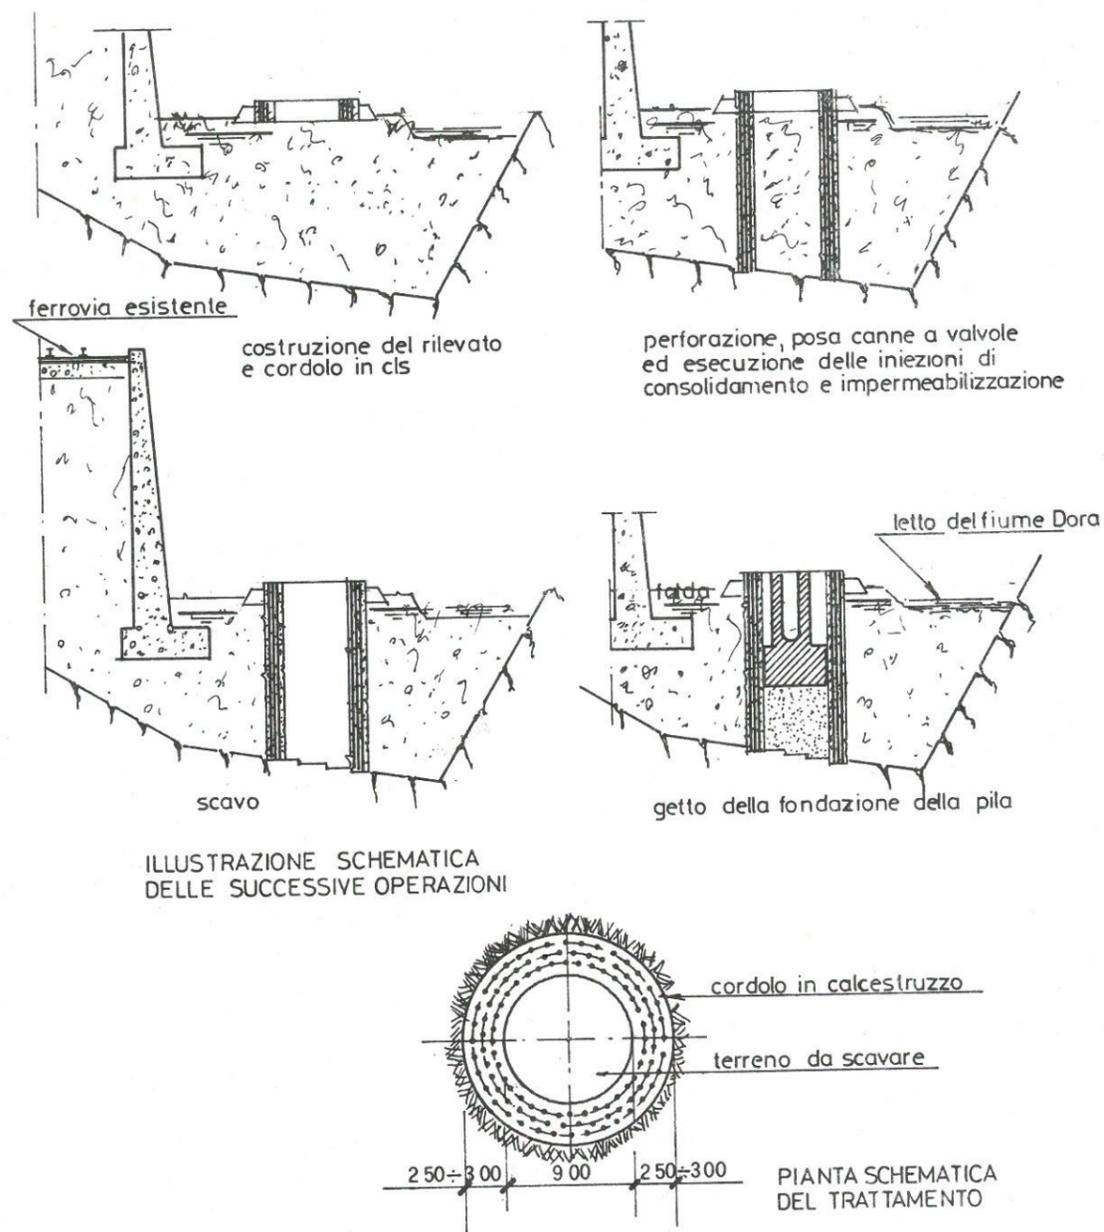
Le varie fasi di un intervento tipo d'iniezioni per lo scavo di un pozzo in falda. Questa situazione particolare si è ritrovata in corrispondenza di una pila del viadotto Montjovet (Autostrada Quincinetto-Aosta).
